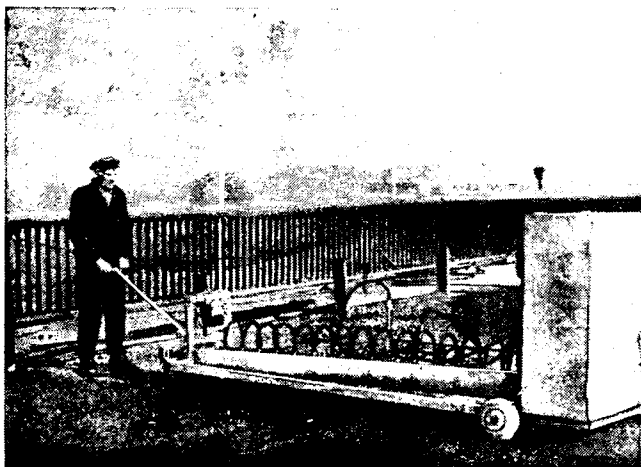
Передвижной линейный разогреватель кромок и стыков
